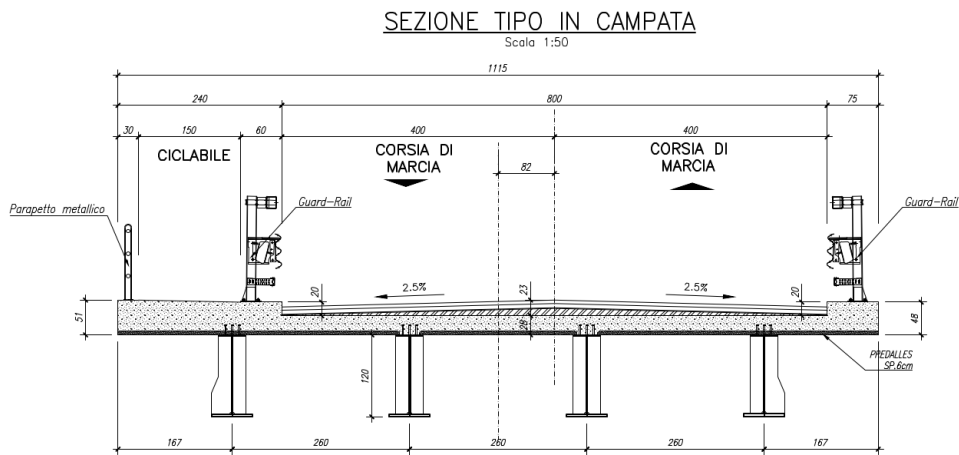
Allargamento Via Barattona: stato di progetto
